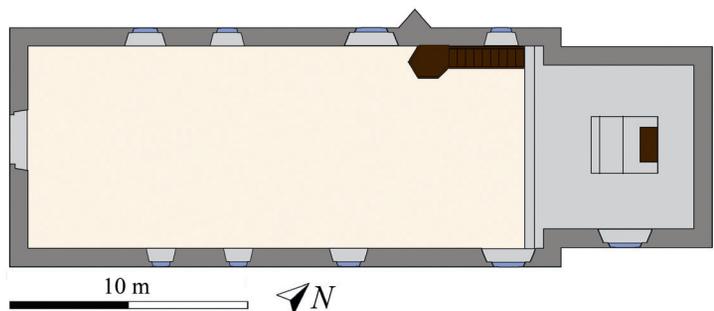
Grundriss der Kirche von 1725 nach KERN 1987 (fs).
